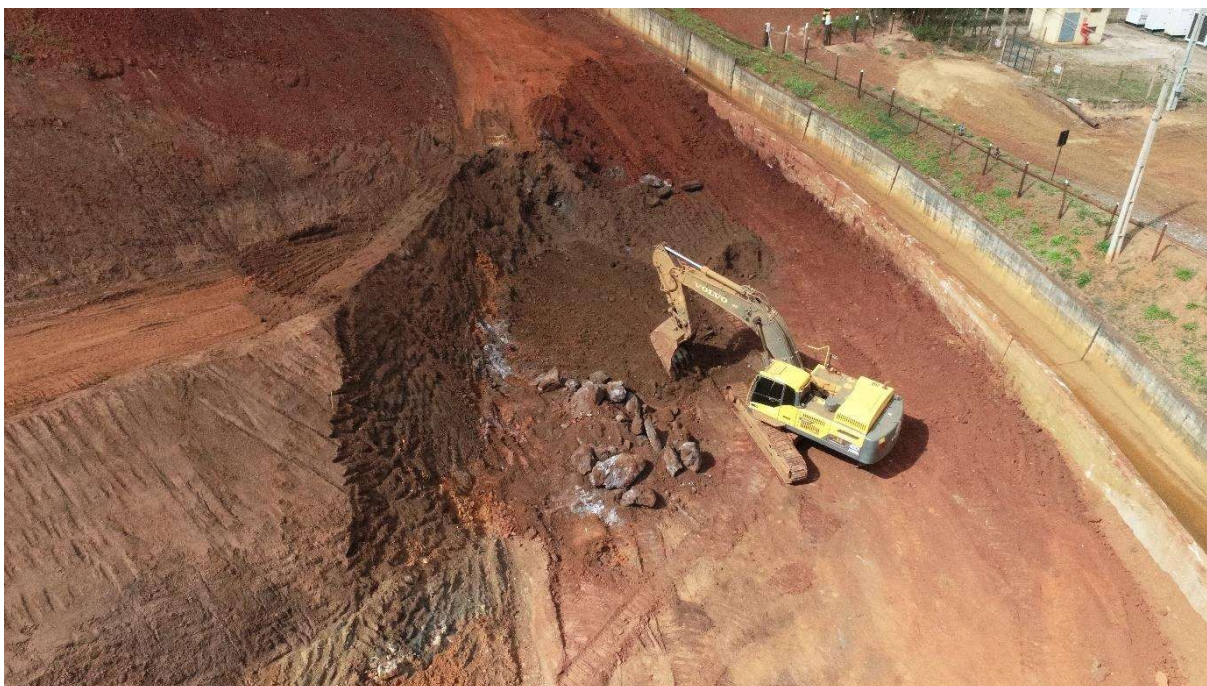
Detalhe da escavação próximo a parede do vertedouro
